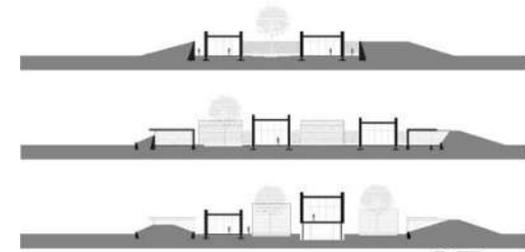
Cortes arquitectónicos del proyecto, fuente: Archidaly.
